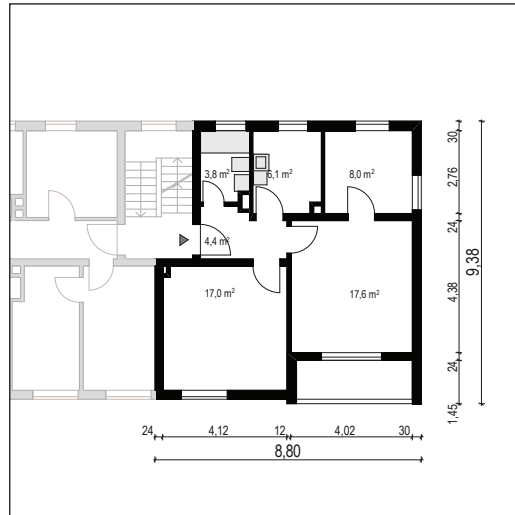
Beispielgrundriss Weiden, Karlsbaderstraße 2
